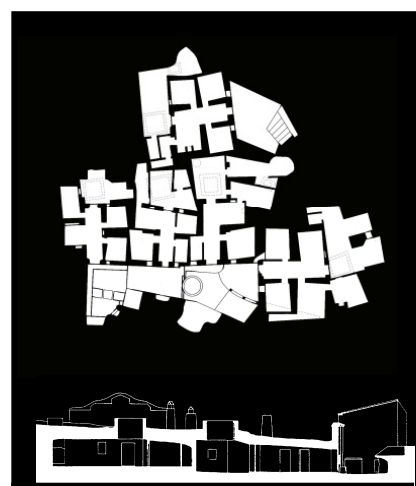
/ 17 – Planta e corte de habitação em “cuevas de la Torre”, Paterna
